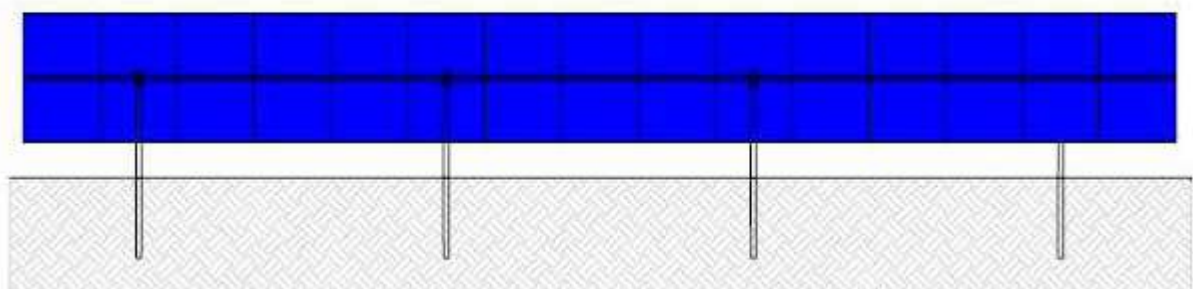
Pannelli su struttura fissa - vista in prospettiva
